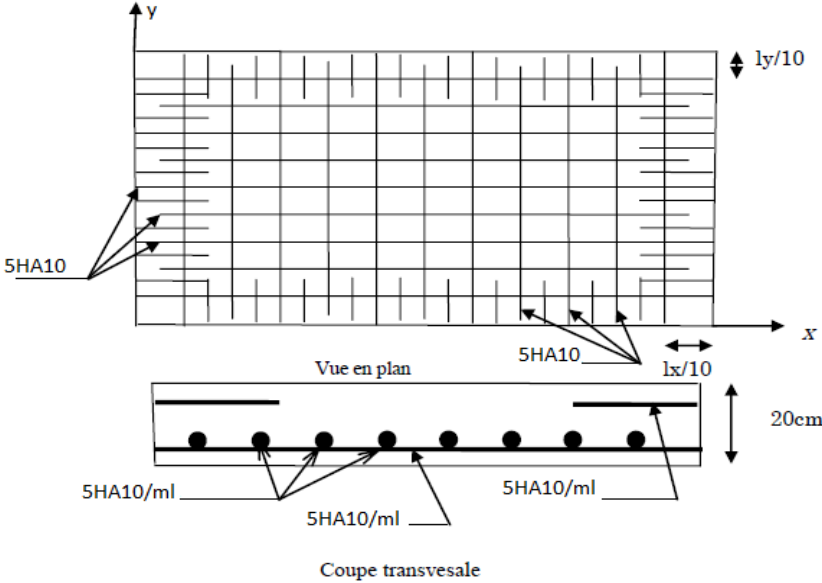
Schéma de ferrailage de la dalle d'ascenseur
